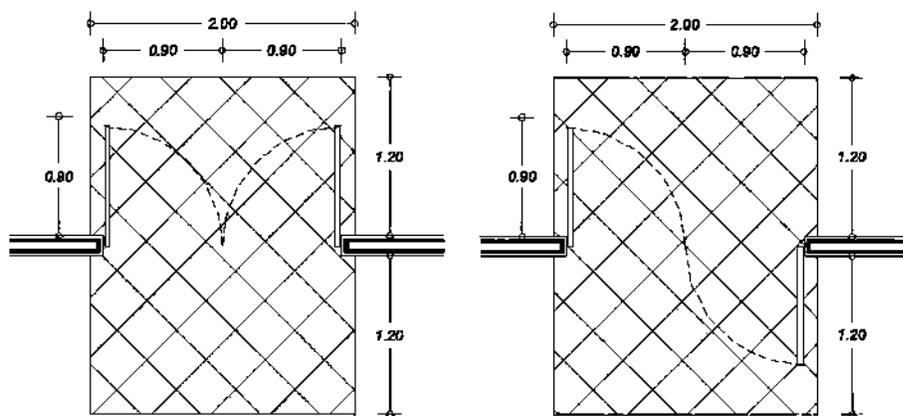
, DIMENSIONES DE PUERTAS PARA MINUSVÁLIDOS, FUENTE: CABIN, p. 22
